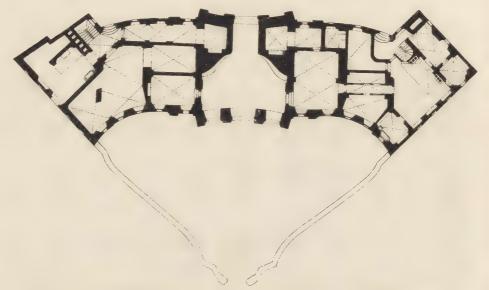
Erbdrostenhof zu Münster i. W. Grundriss des Erdgeschosses.
